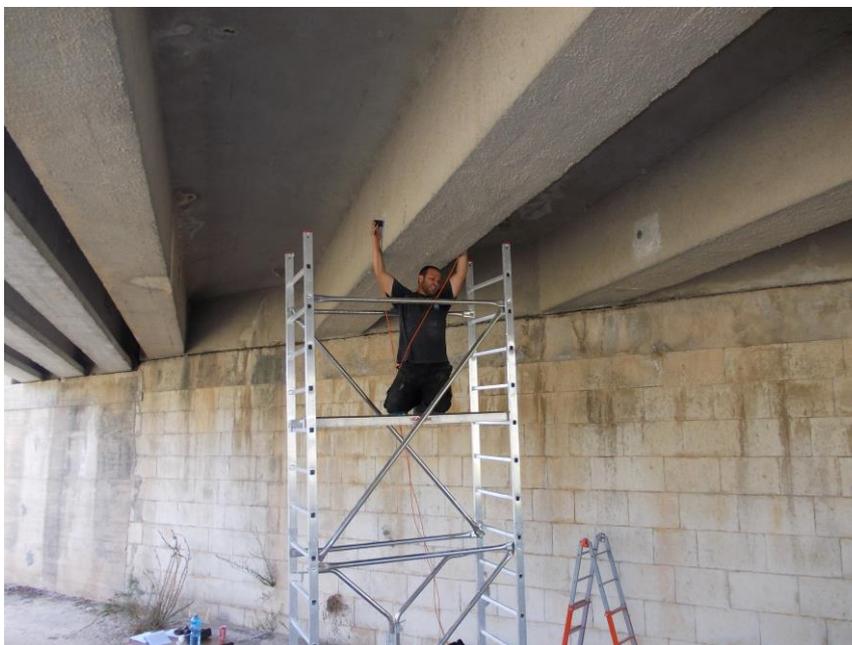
Ponte Salvia – Spalla lato Pozzallo – Esecuzione della prova ultrasonica US2
